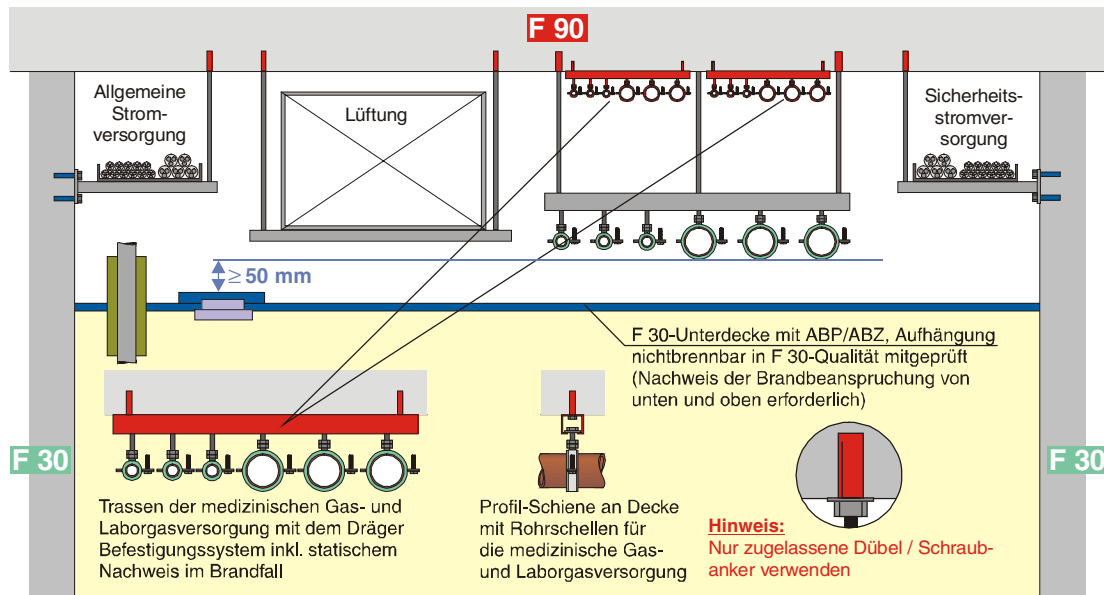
wie Bild 8, jedoch mit klassifizierter Unterdecke, z. B. F 30-Unterdecke
